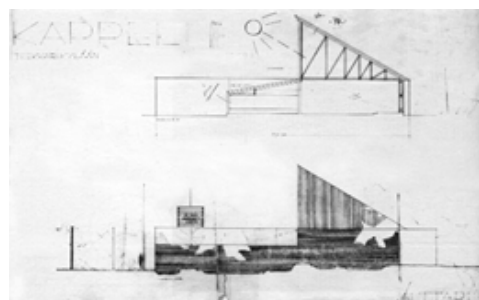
Kaija y Heikki Siren, Capilla de Otaniemi: sección longitudinal del proyecto, en su primera versión, 1956
